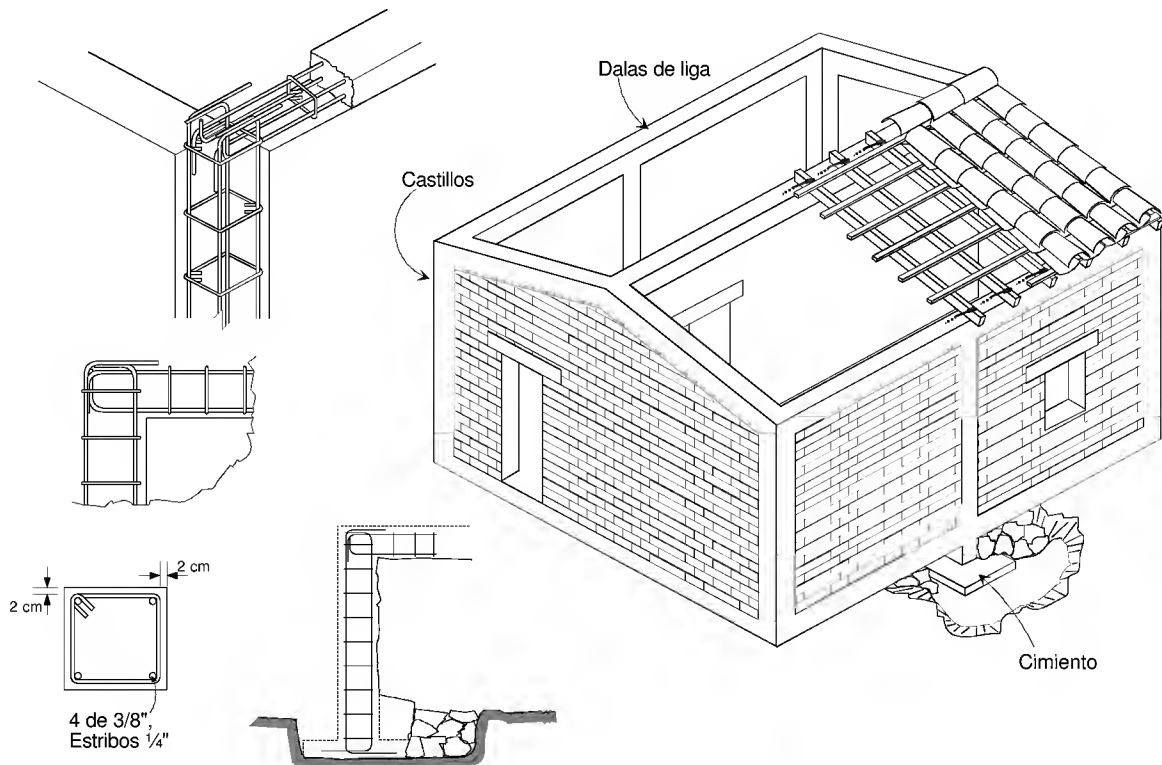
Adición de castillos y dalas de concreto reforzado
